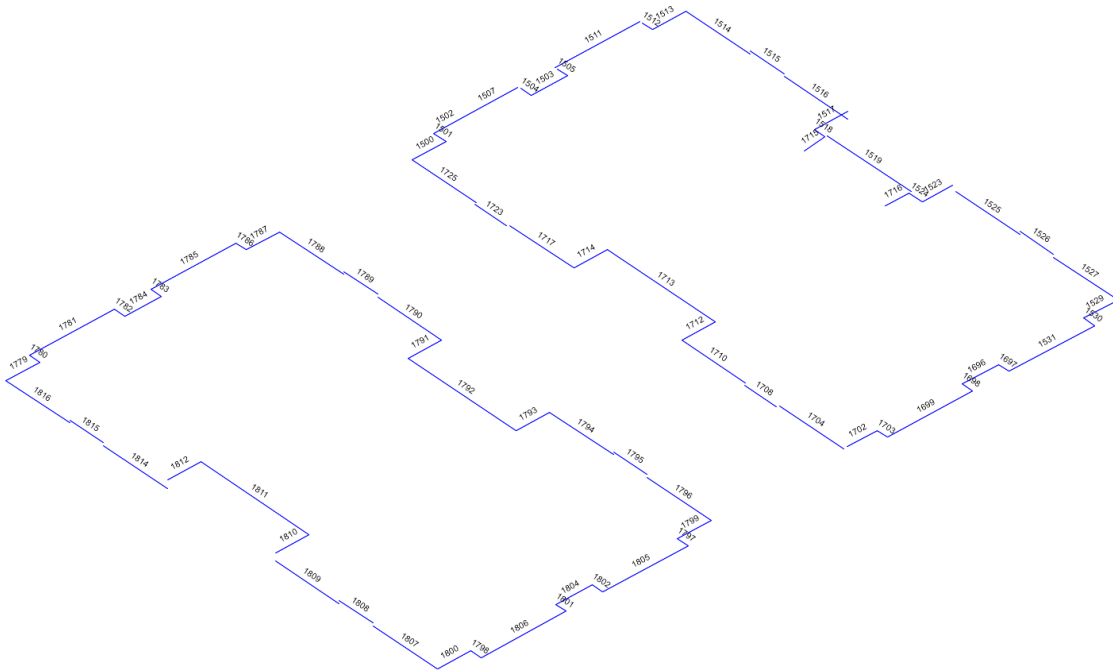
Nomes 'Frames' - Vigas platibanda
